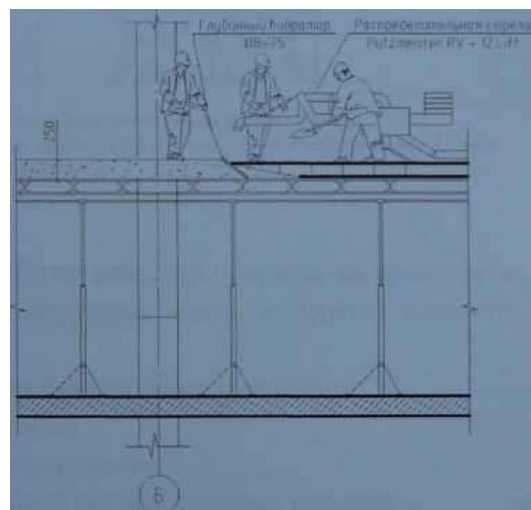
Укладка бетонной смеси для плиты перекрытия
